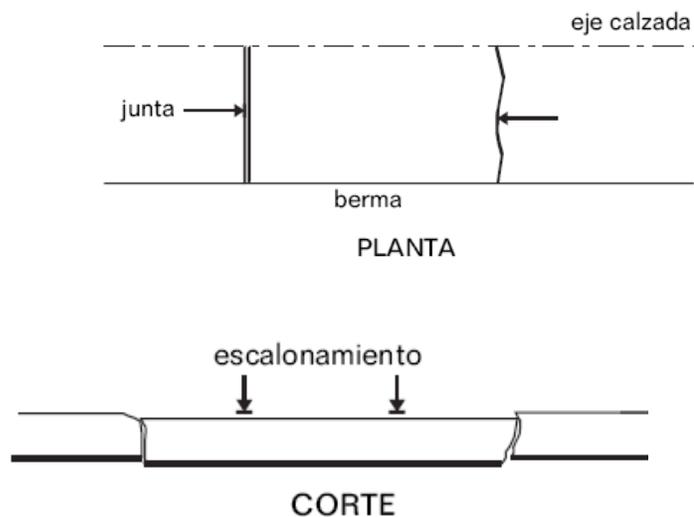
Escalonamiento de Juntas y Grietas
